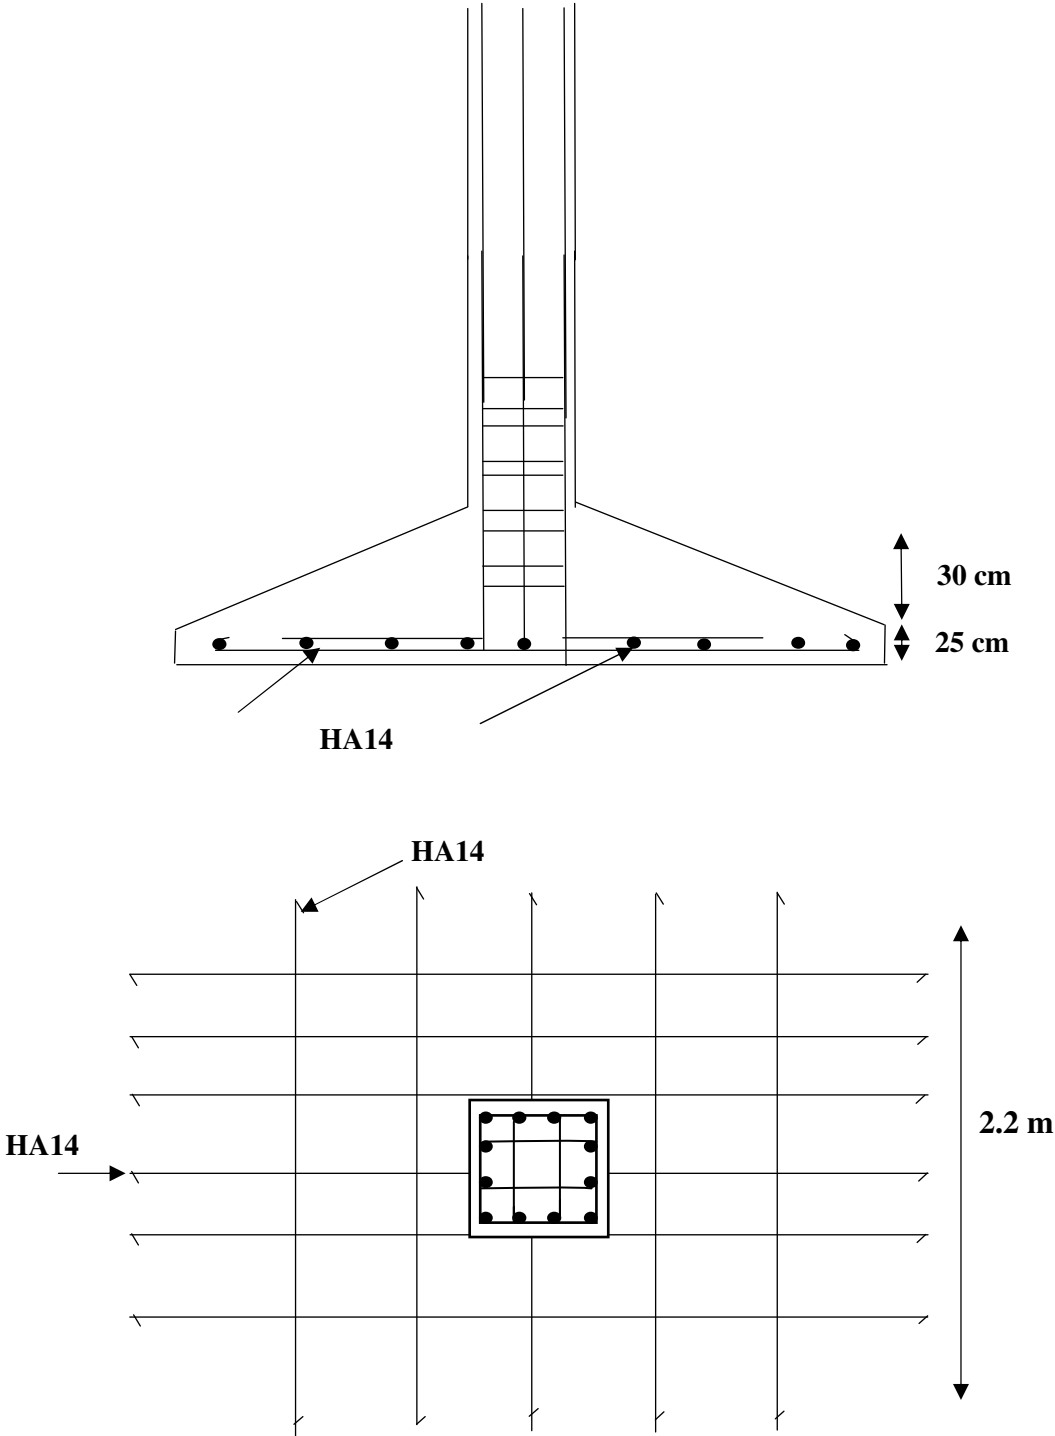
Schéma de ferrailage d'une semelle isolé sous poteaux carré.
